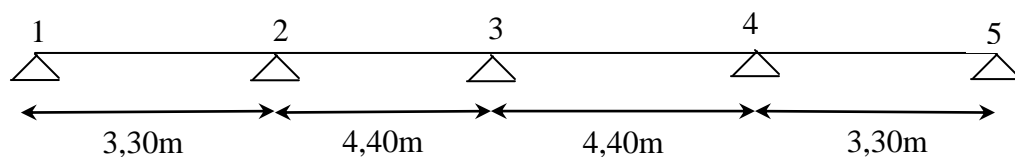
Schéma statique de la poutrelle à quatre travées
